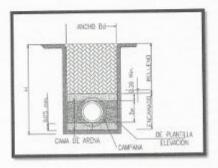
Esquema de zanjas para instalación de tubería
